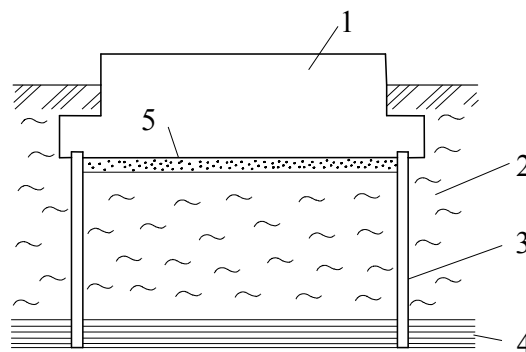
Посилення ґрунтової основи шляхом влаштування шпунтового огородження; 1 – фундамент; 2 – слабкий ґрунт; 3 – шпунтове огородження; 4 – щільний ґрунт; 5 – піщана підготовка
